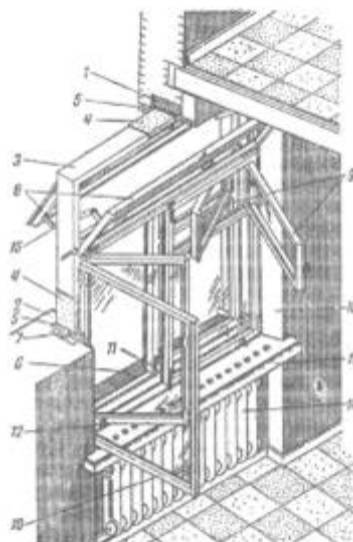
Конструкция обычного оконного проема: 1— железобетонная перемычка; 2— оконная четверть; 3— оконная коробка; 4— гидроизоляция оконной коробки; 5— конопатка; 6— подоконный наружный слив; 7— закладная пробка в стене для крепления коробки; 8— фрамуга; 9— форточка; 10— створка оконного переплета; 11— штапик; 12— ветроостанов; 13— подоконная доска; 14— ниша подоконного отопительного прибора; 15— штанга фрамуги; 16— оконный откос
